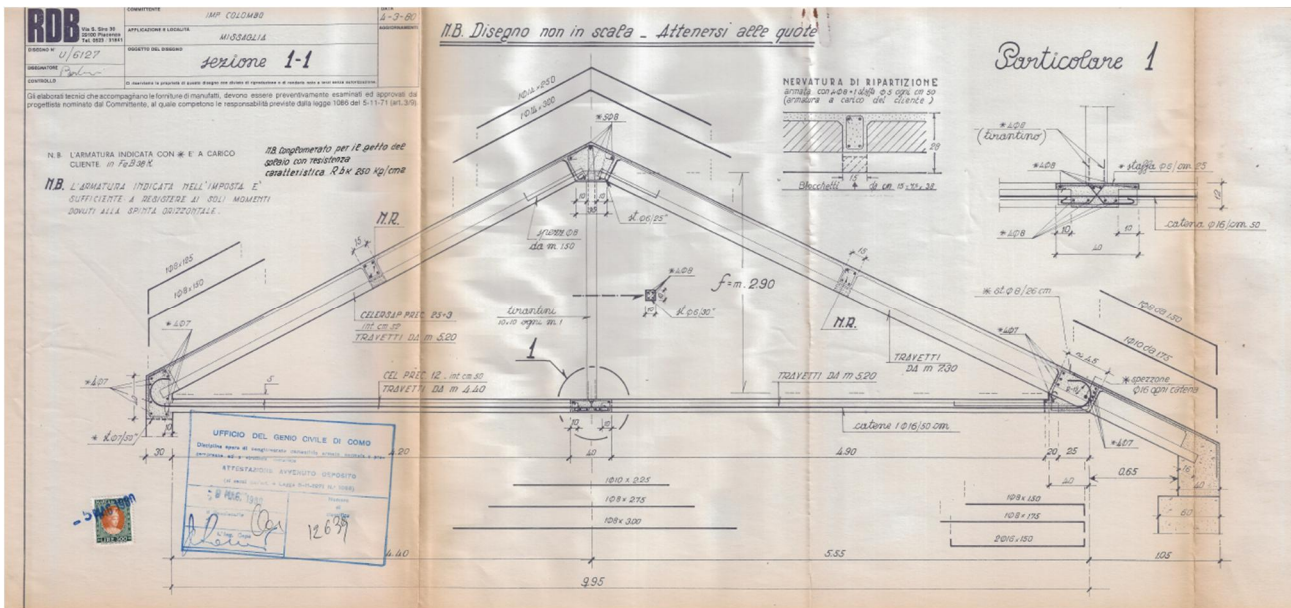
Sezione strutturale del sistema di copertura dell'edificio "palestra"
